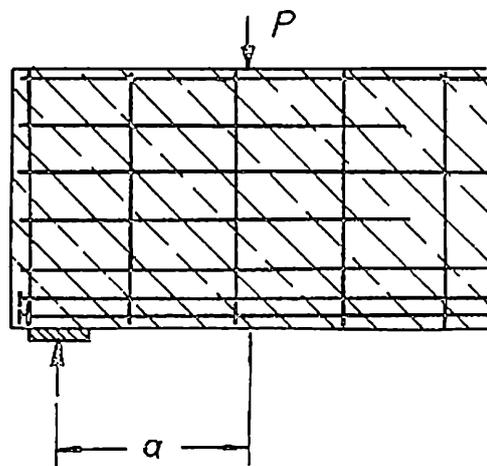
14. Для нагрузок, расположенных близ опор, отгибы недопустимы
